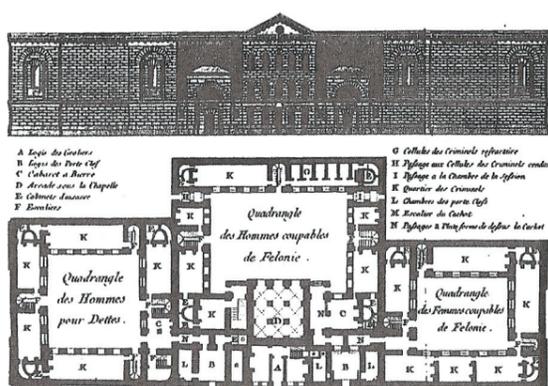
Grundriss | Ansicht Newgate Prison
